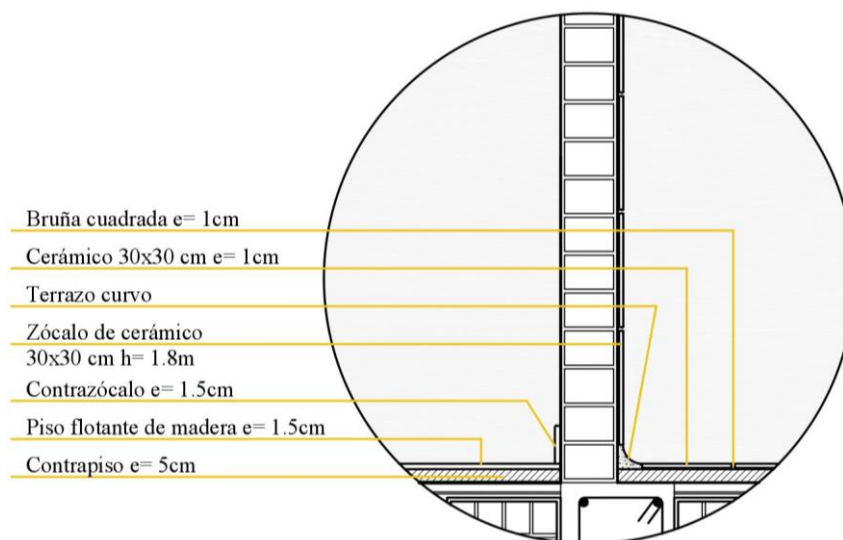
Detalle de piso flotante de madera y de piso de cerámico 30x30 cm. Fuente: Propia
